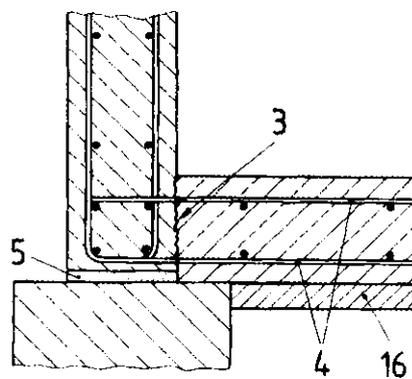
Behälterwand aus Stahlbetonfertigteilen, Stahlbetonsohle nachträglich betoniert
